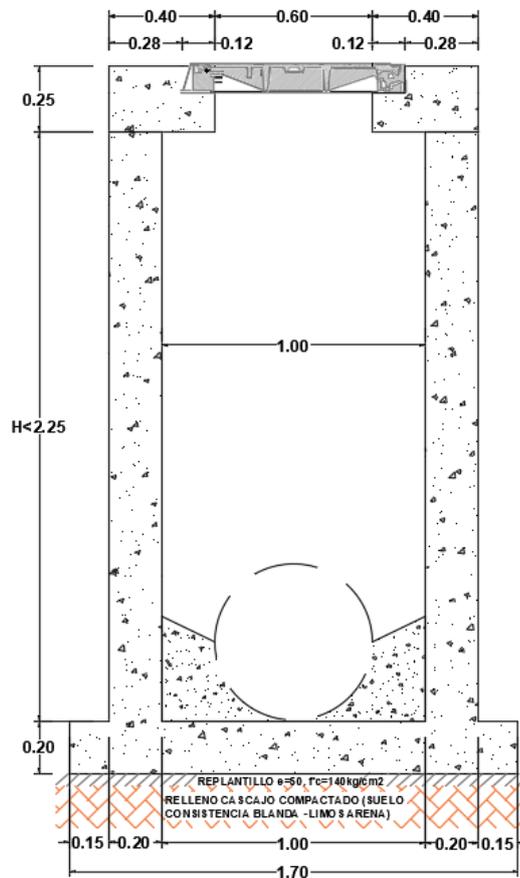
6 Detalles de los pozos de inspección. (Elaboración propia, 2021)
